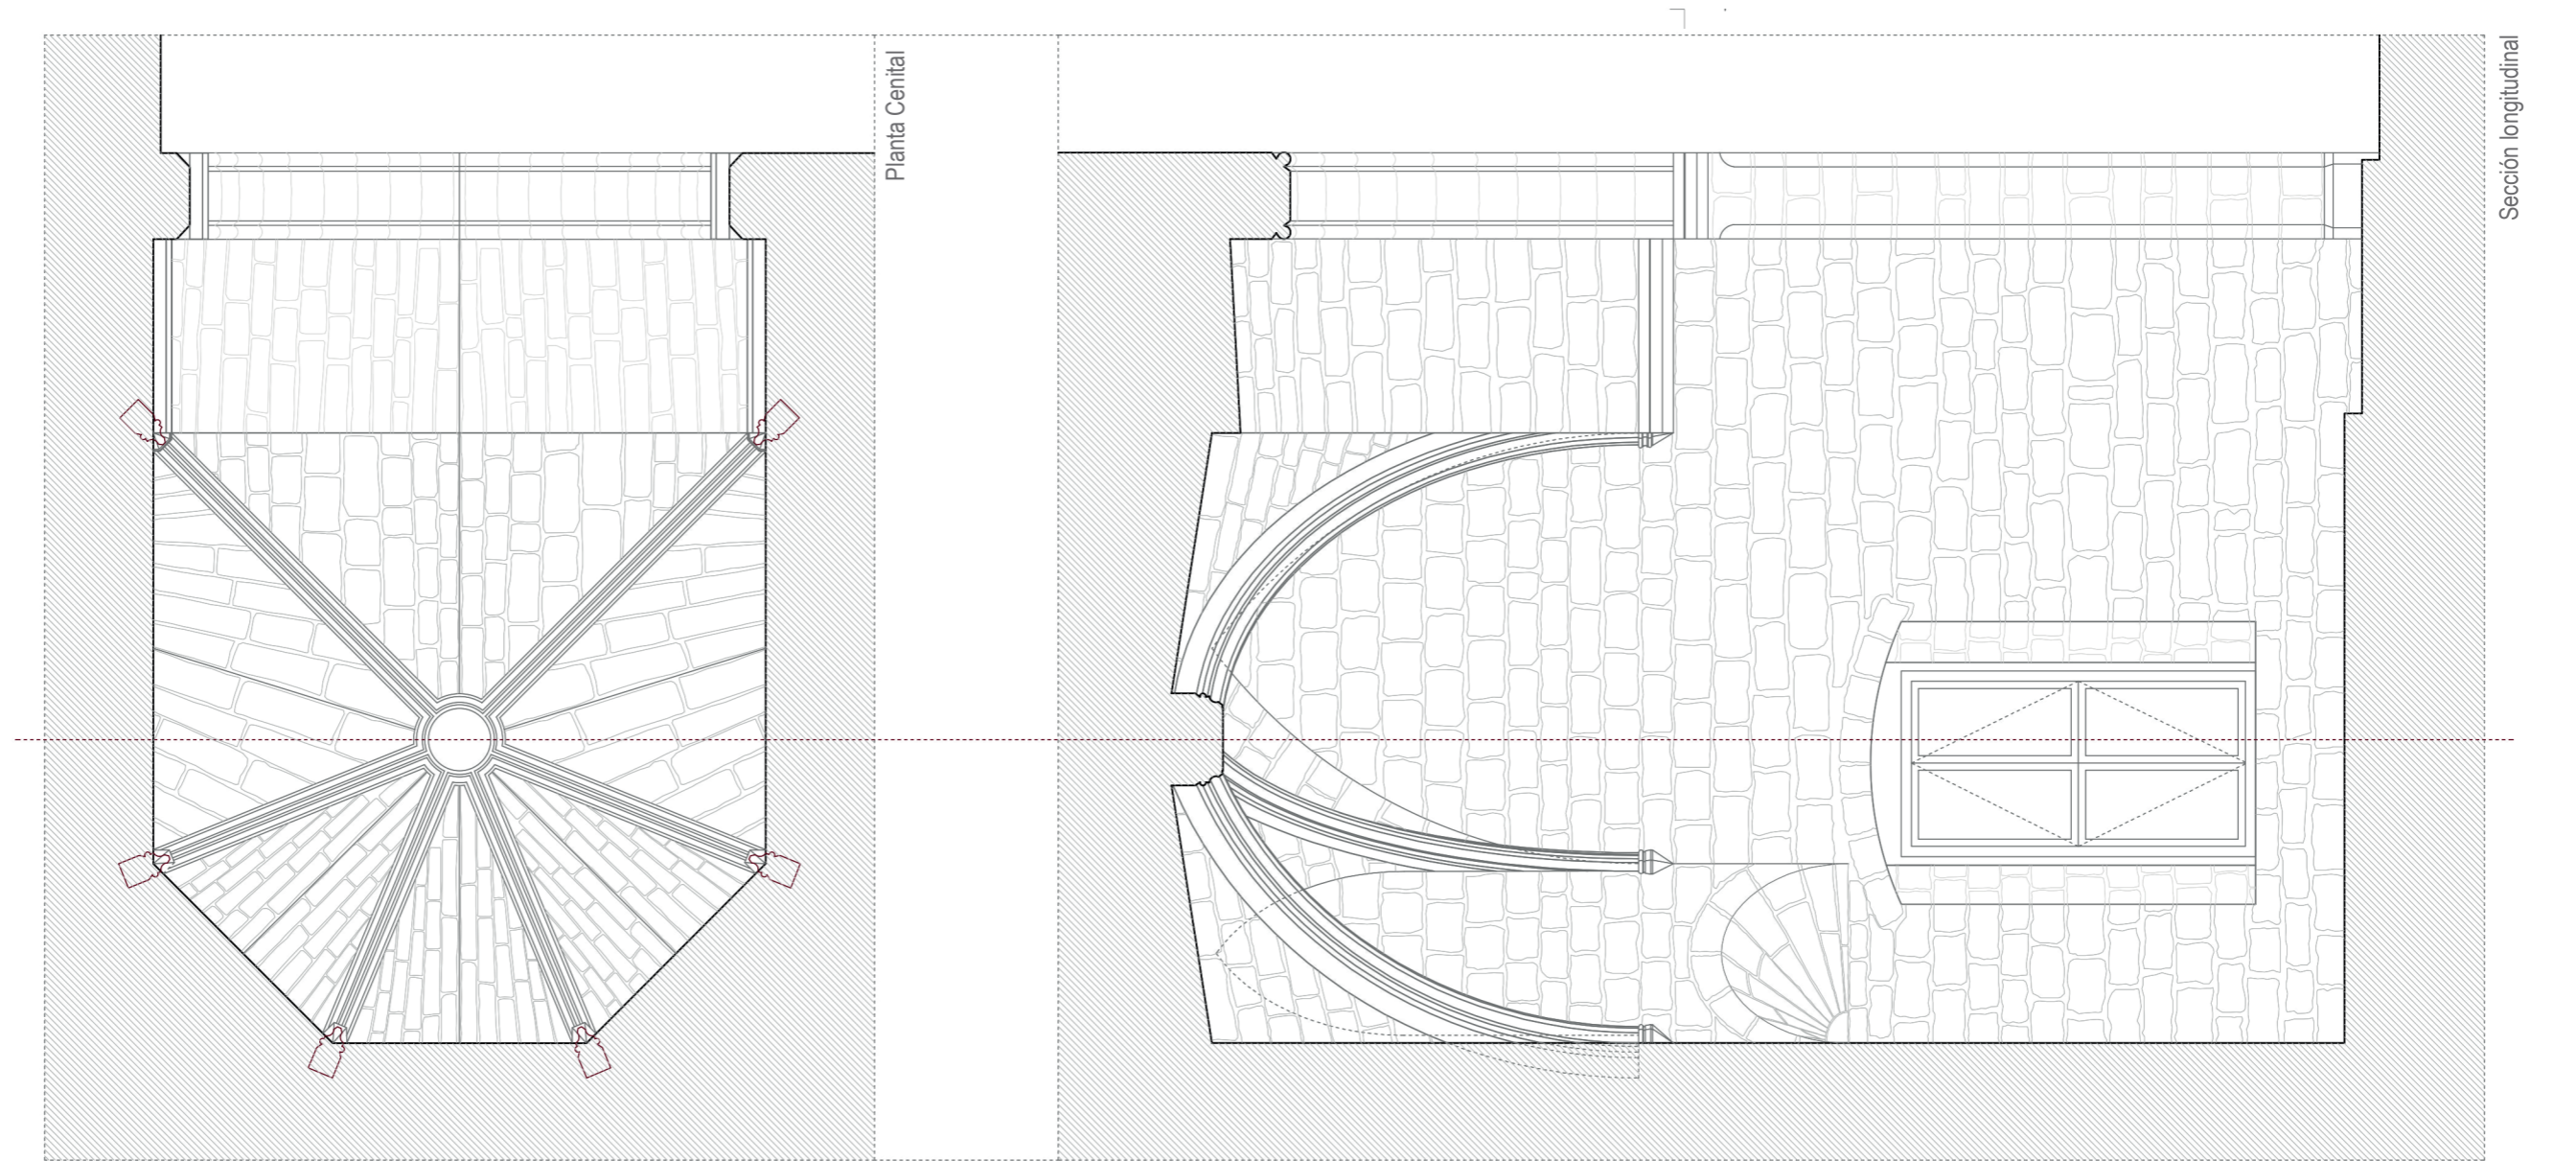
Planta y sección de la capilla a escala 1:50 (Dibujo propio)
